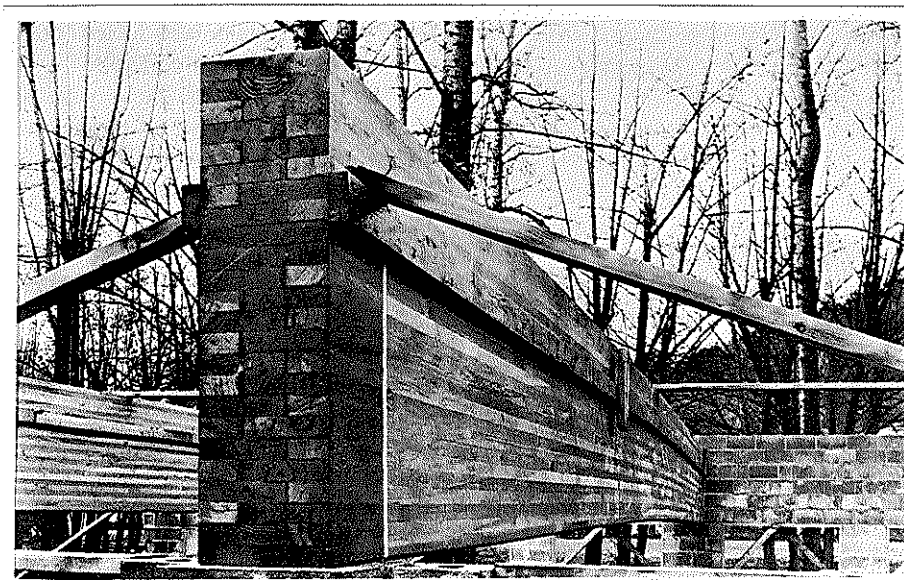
Viga reta de uma pista de dança ,OBERG (1963)
